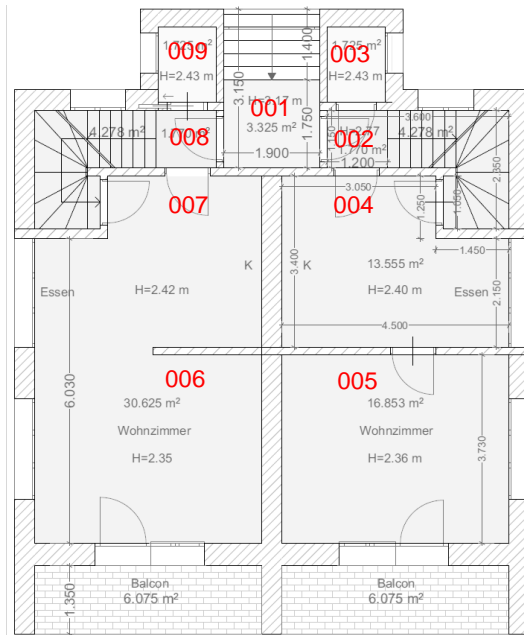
Abb. 2: Grundriss Hochparterre.
